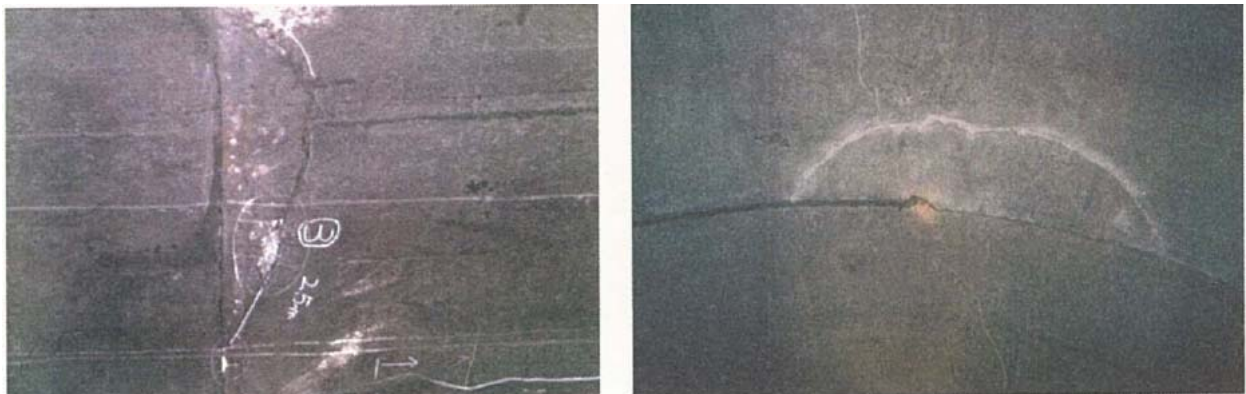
横断方向目地の天端付近に発生した半月状のひび割れの例
